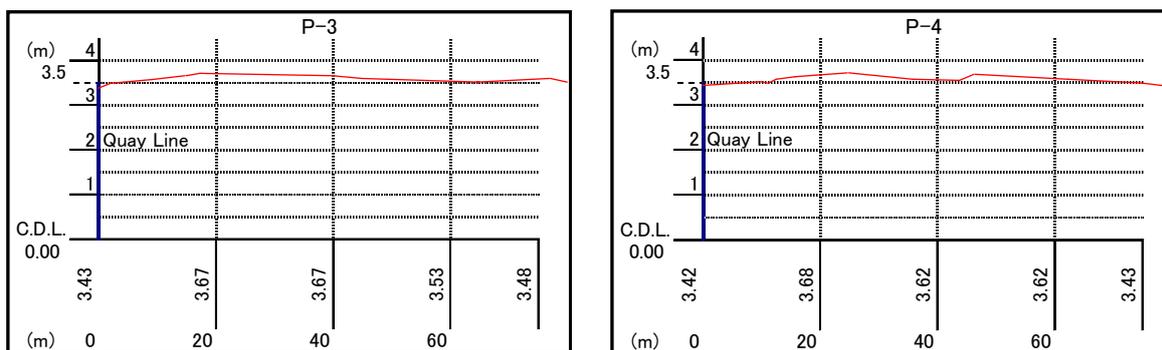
Secções P-3 e P-4 do Cais Norte
